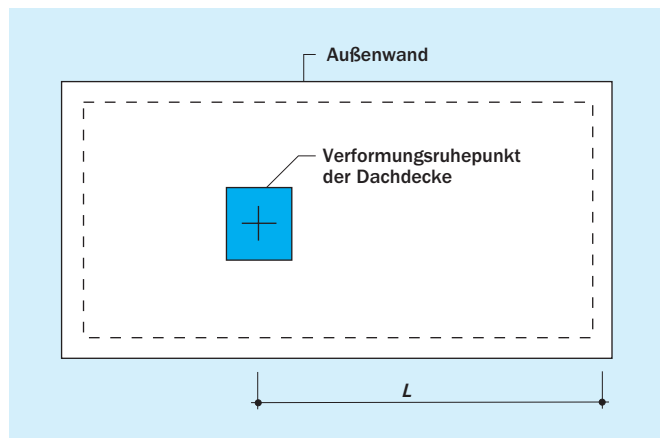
Maßgebliche Verschiebelänge, Dach-Draufsicht
